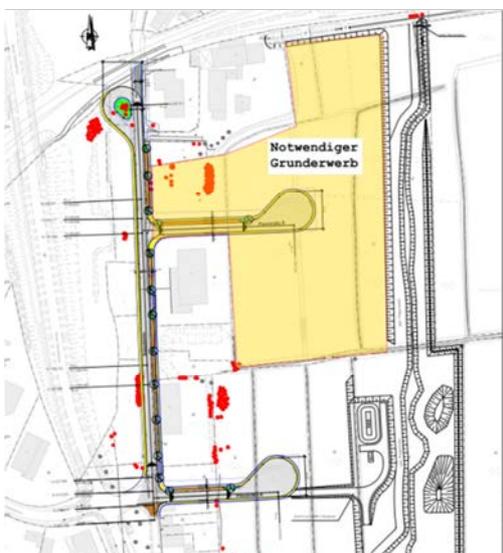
GG Steindamm - Erforderlicher Grunderwerb zur Flächenentwicklung im 2.BA B-Plan 1202
